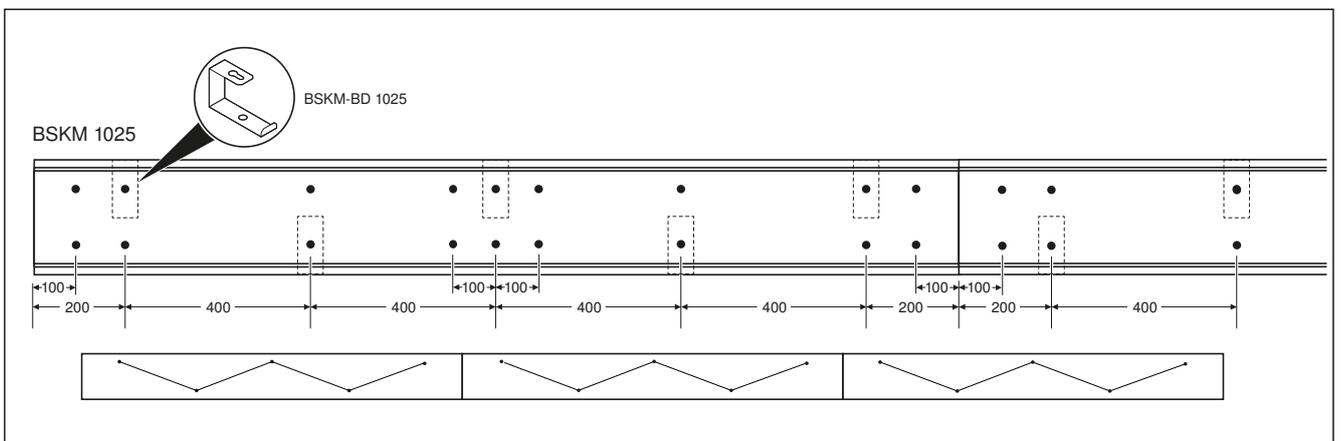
Lochbild für Deckenmontage, BSKM 1025
